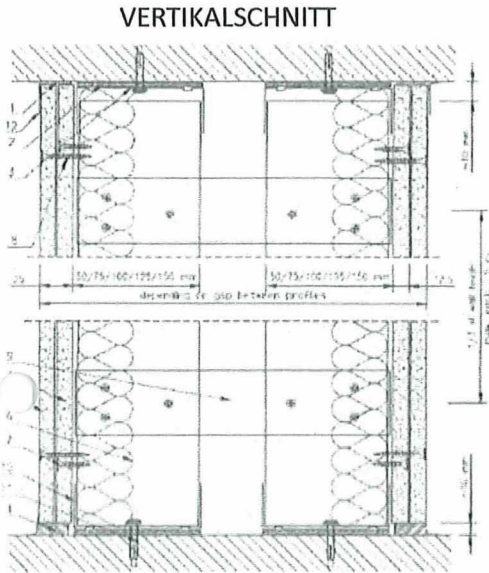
Einbruchshemmende nichttragende zweilagige Trennwände mit doppeltem Ständerwerk (mit getrennten Ständern) – für Installationswände
